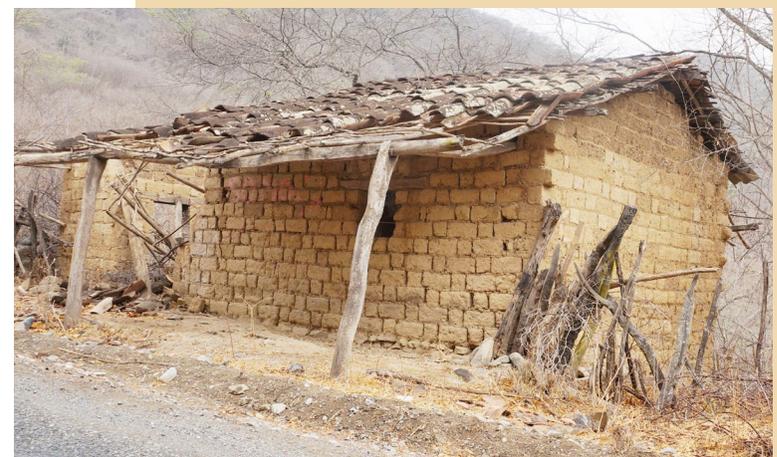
Vivienda en Zapotillo - Construcción: Adobe
